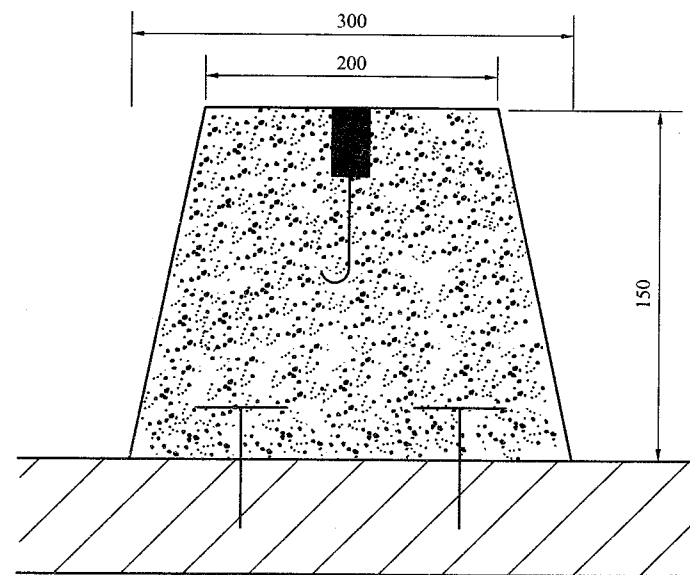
混凝土三角高程点建筑顶标石 (单位: mm)
